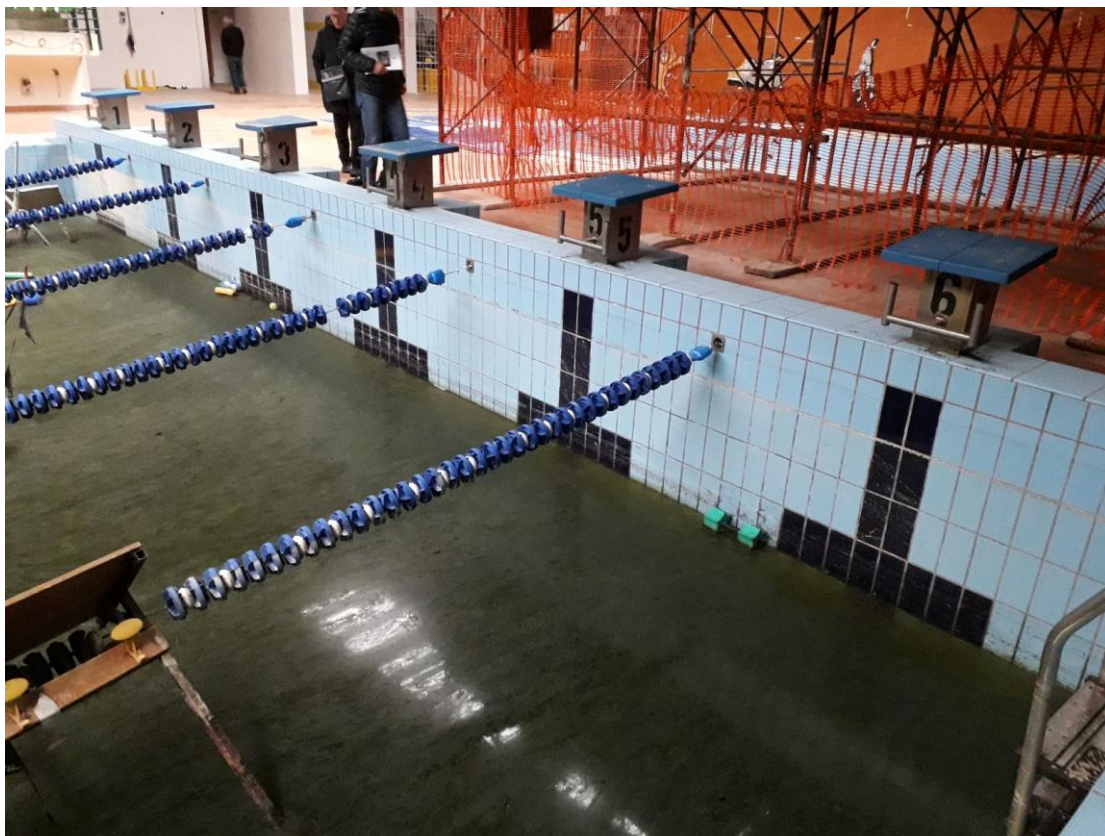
vasca 25 m (ponteggio sotto trave legno danneggiata)
